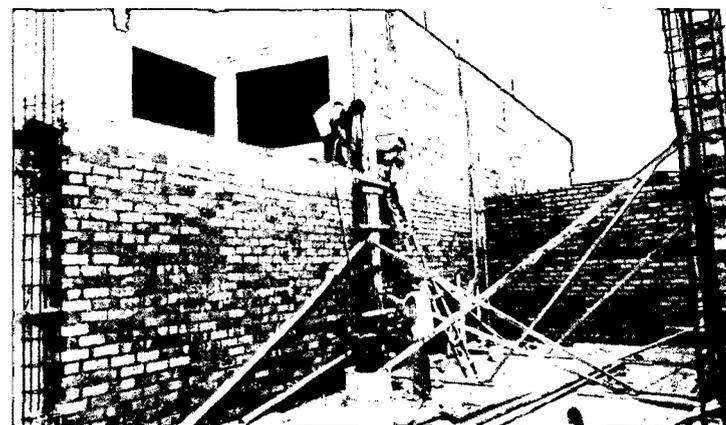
Realizando la prueba del slump en campo, de concreto hecho al pie de obra para columnas.
